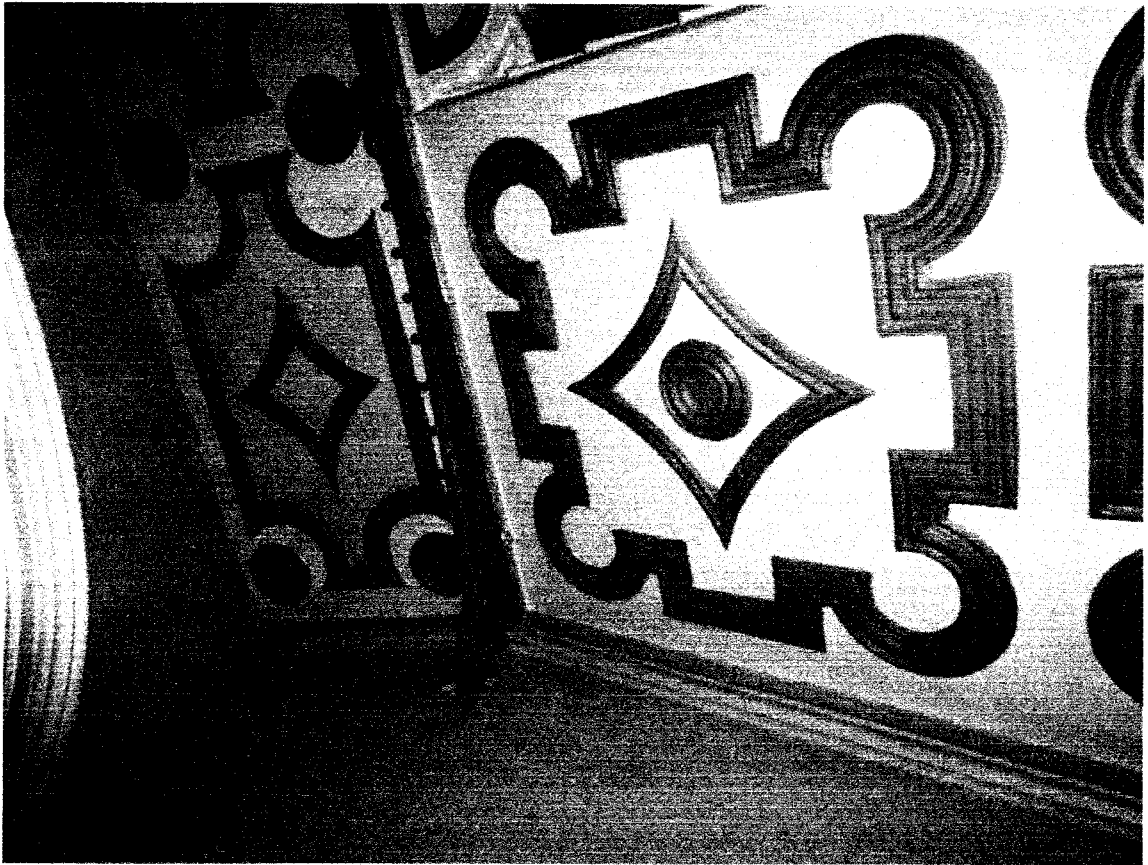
Помещение 14. Кронштейн и филенки под лестничным маршем
